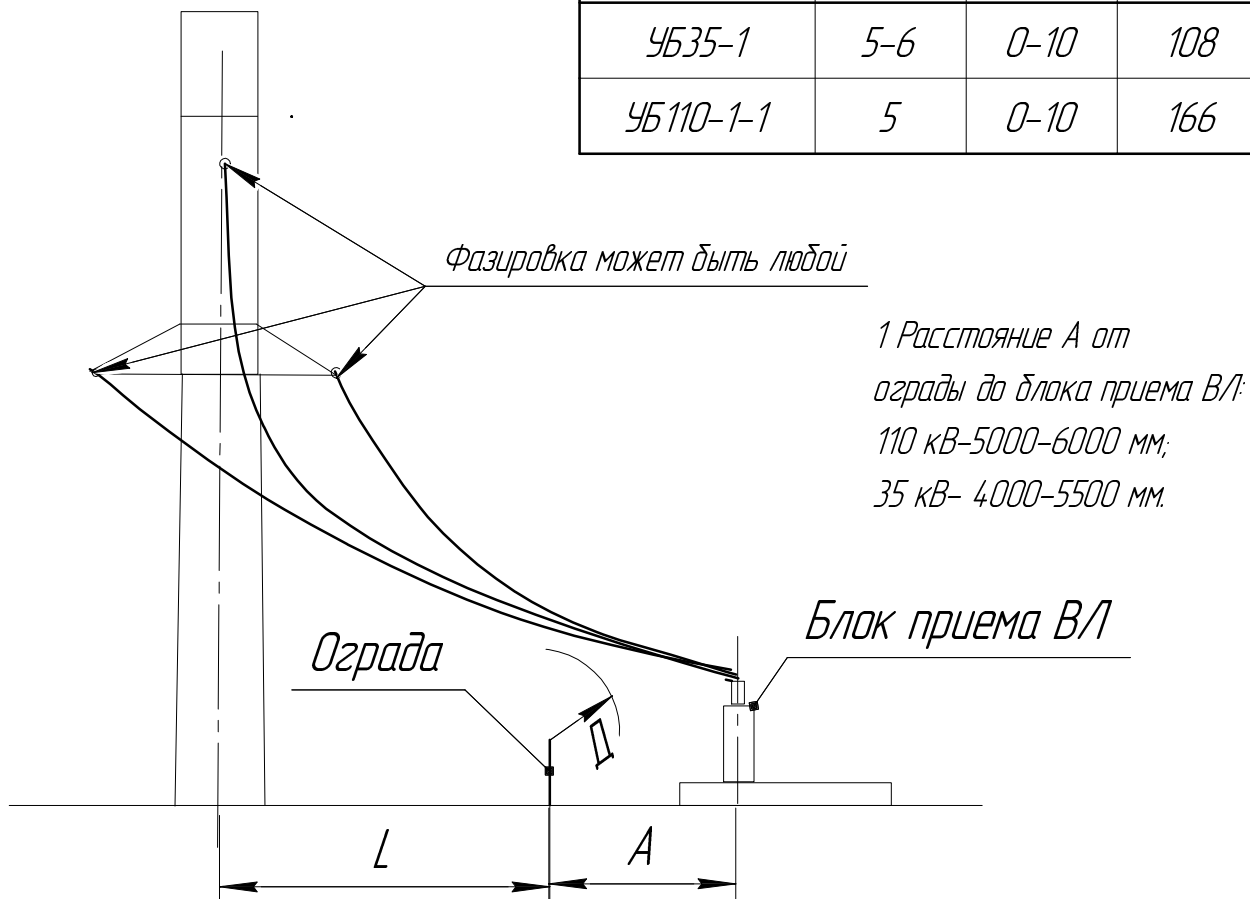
Беспортальный прием двух ВЛ с двухцепной железобетонной опоры
